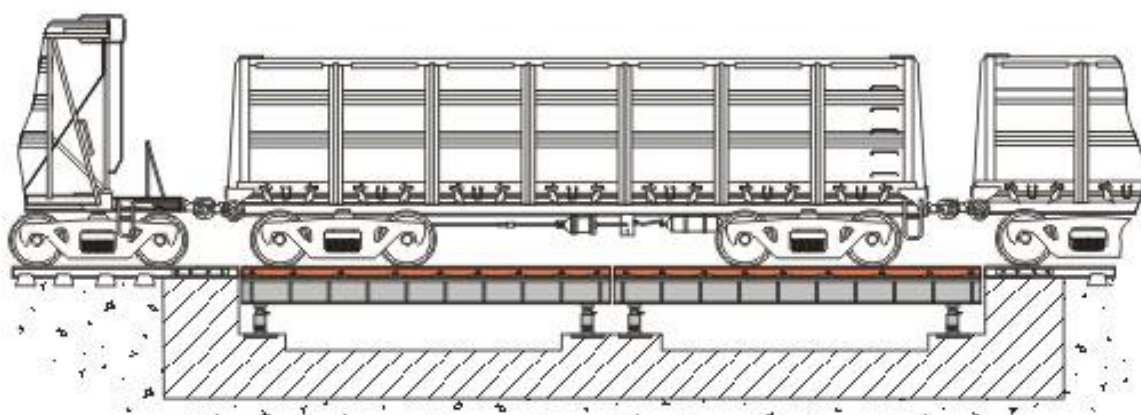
ГПУ весов с двумя взвешивающими секциями (грузоприемными платформами), установленное на железобетонный фундамент
